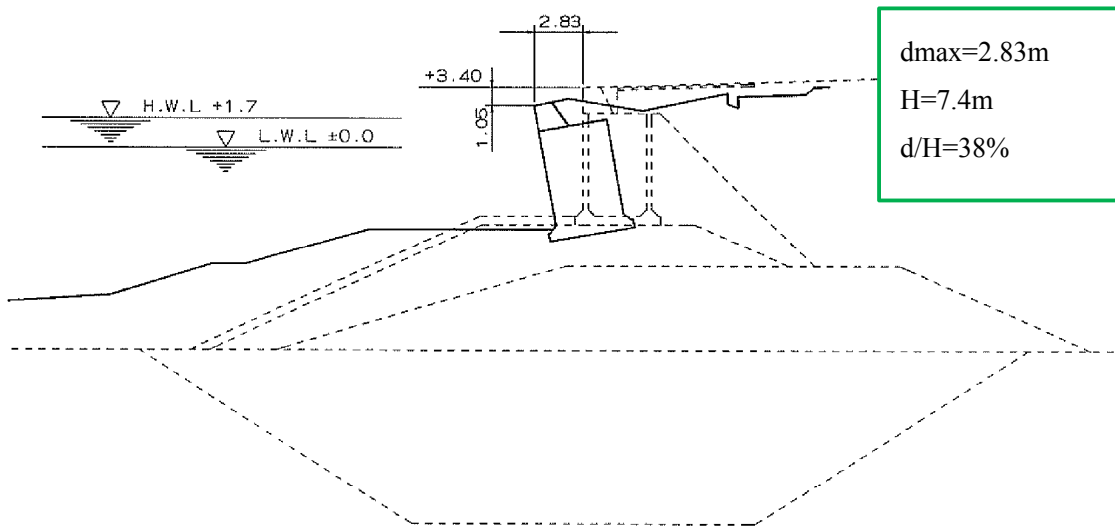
物揚場その3 (-4m) ⑩標準断面図及び被災状況断面図
